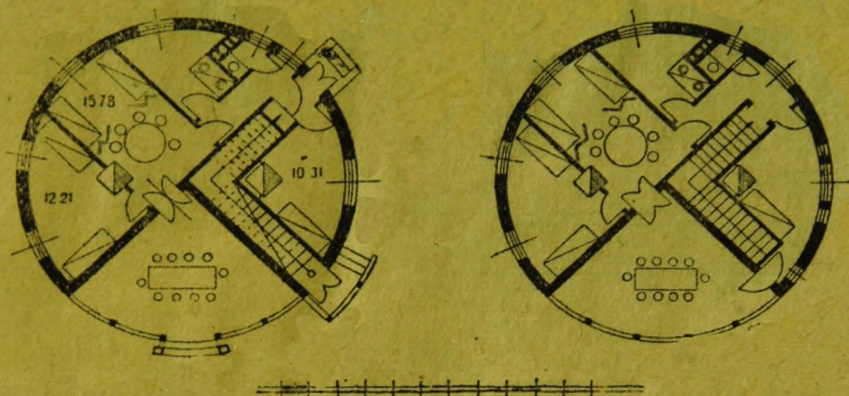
Двухэтажный круглый глино-плетневый дом. План I и II этажа
